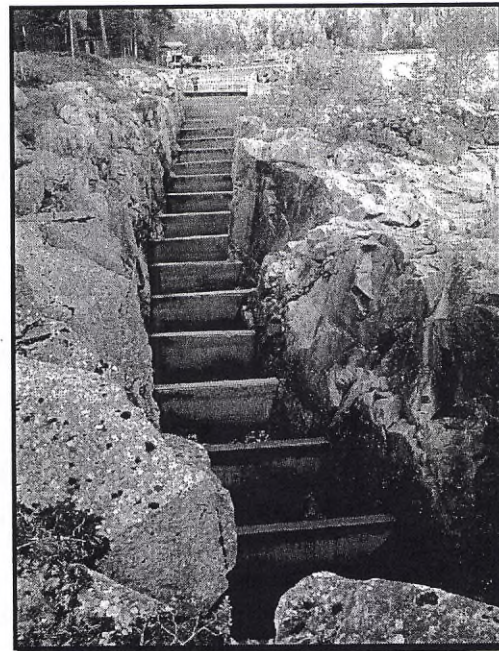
Fiskvägen avstängd, Jockfall Kalixälven 2000. Foto Stefan Stridsman.
